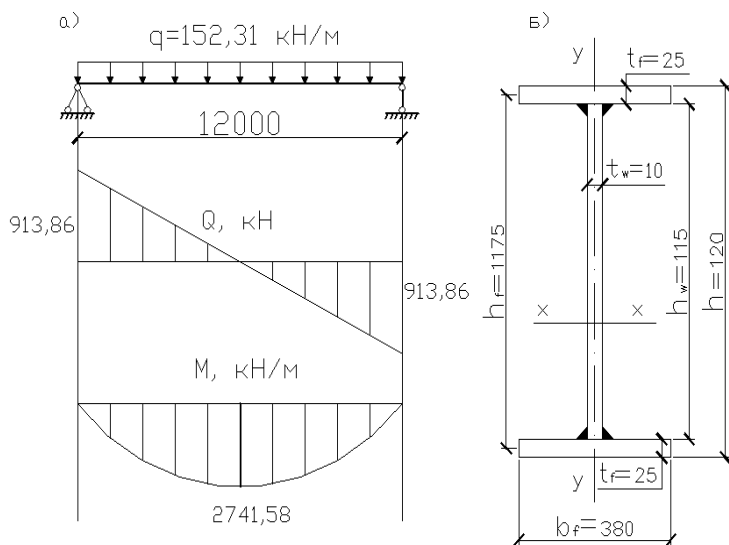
Розрахункова схема головної балки з епіюрами Q і M (а) та поперечний переріз головної балки (б)
